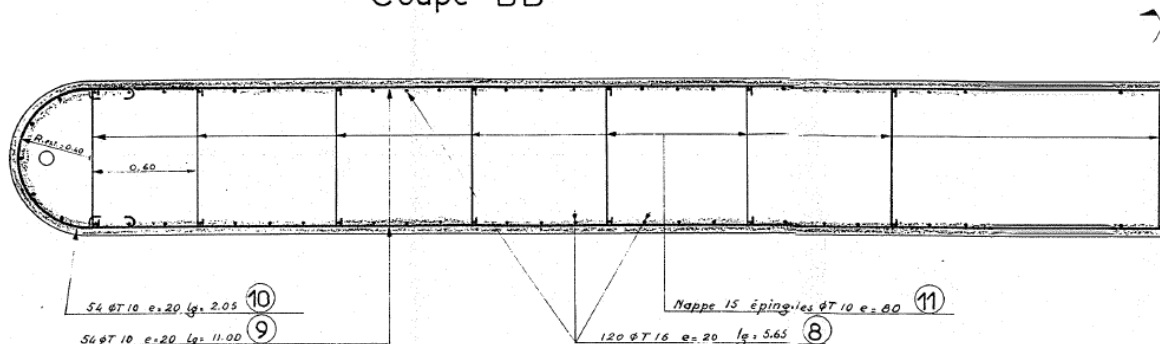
Plan de ferrailage des piles – Coupe longitudinale
